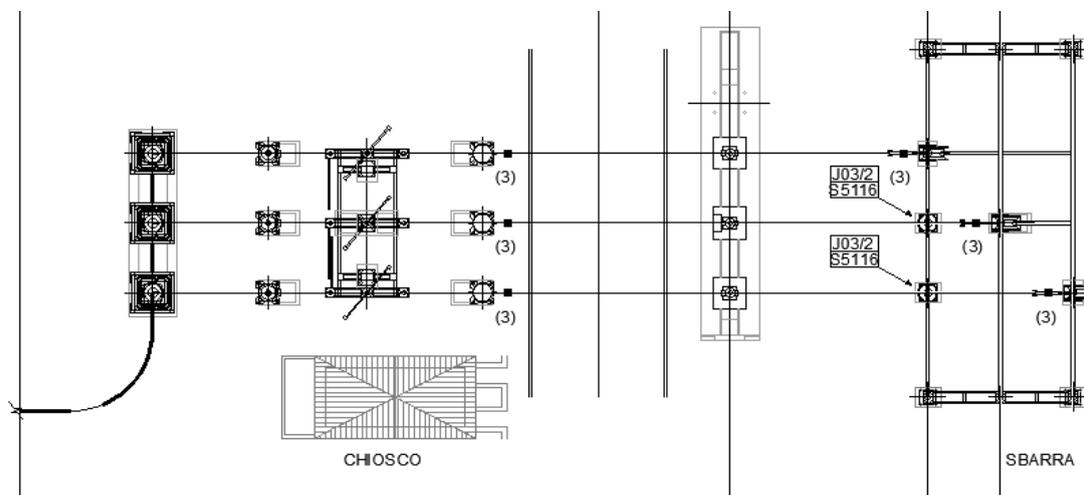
Planimetria elettromeccanica tipologica stallo di consegna TERNA
